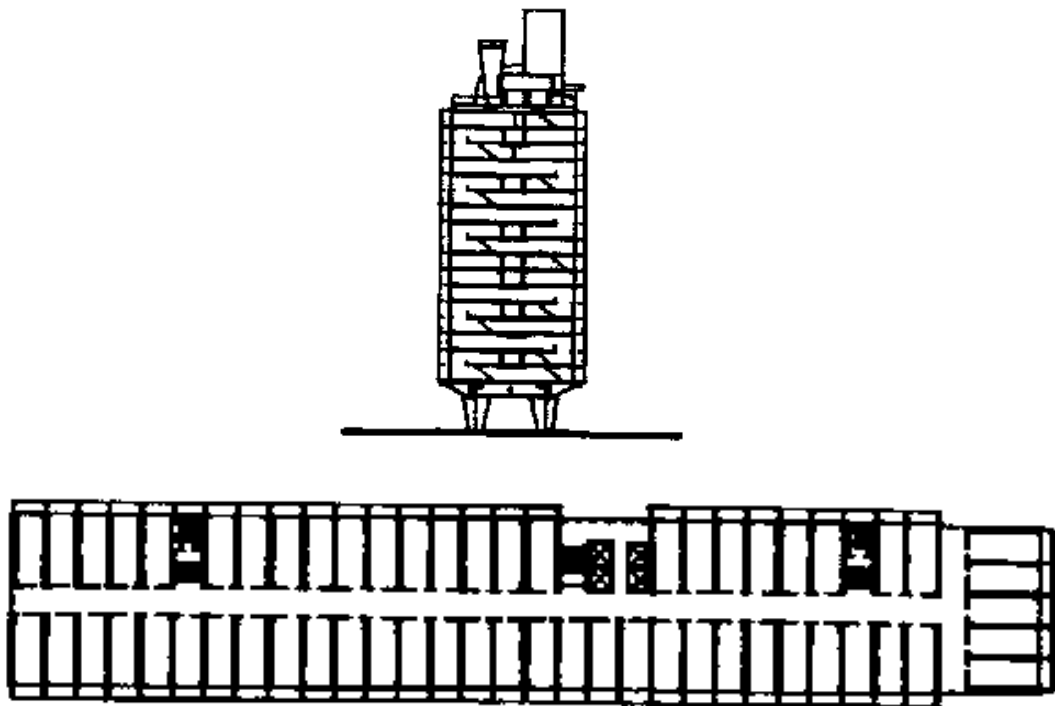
Corte transversal y planta de la Unidad Habitacional de Marsella.
